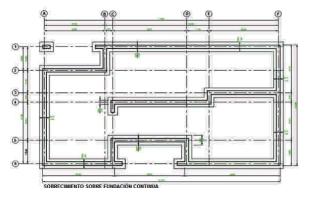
27 : Plano de fundación de vivienda prototipo y corte de la solución tipo.
